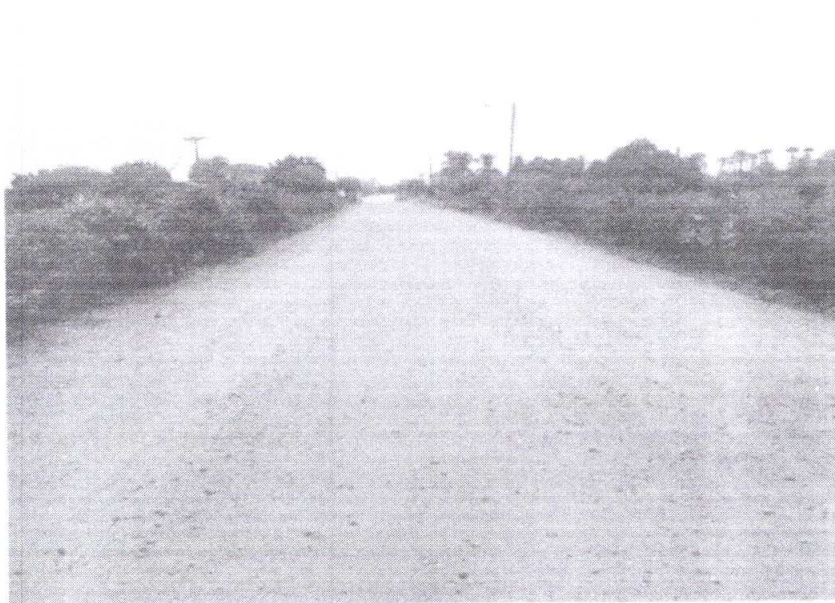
Rua Professora Mercês (passagem do bueiro)
